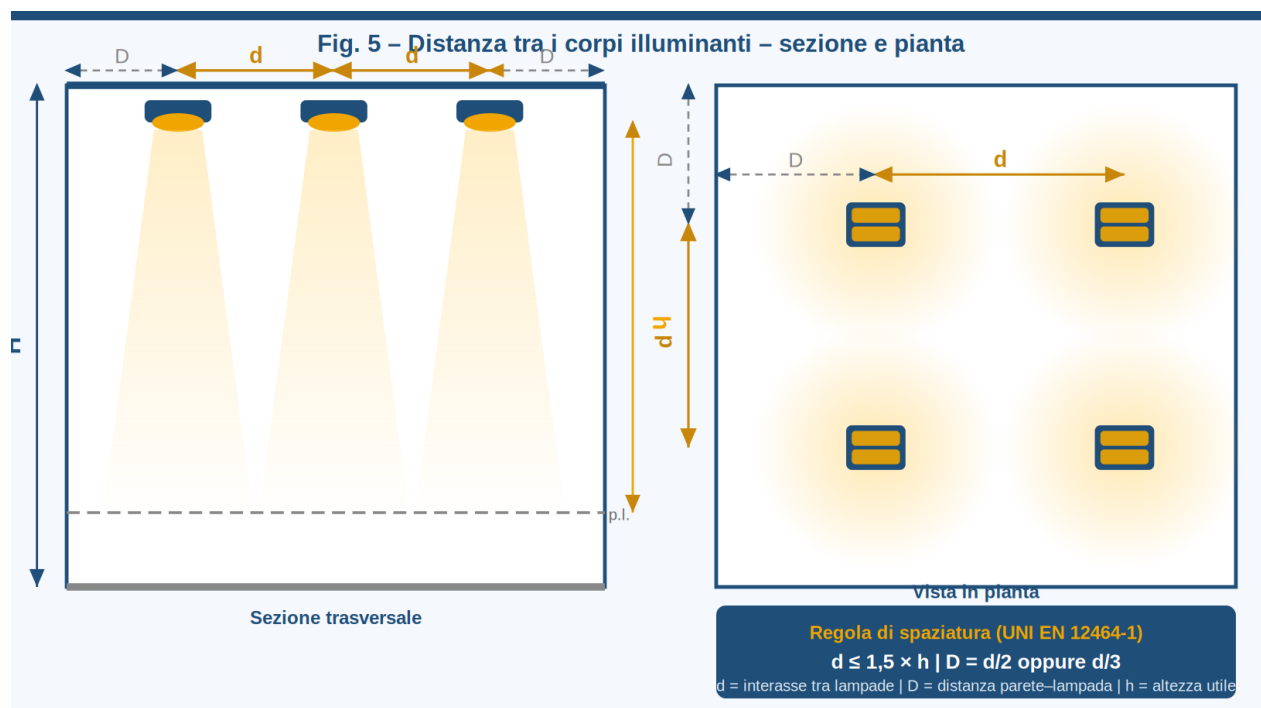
Distanza tra i corpi illuminanti: sezione trasversale (sin.) e vista in pianta (des.). d = interasse; D = distanza parete-lampada.
